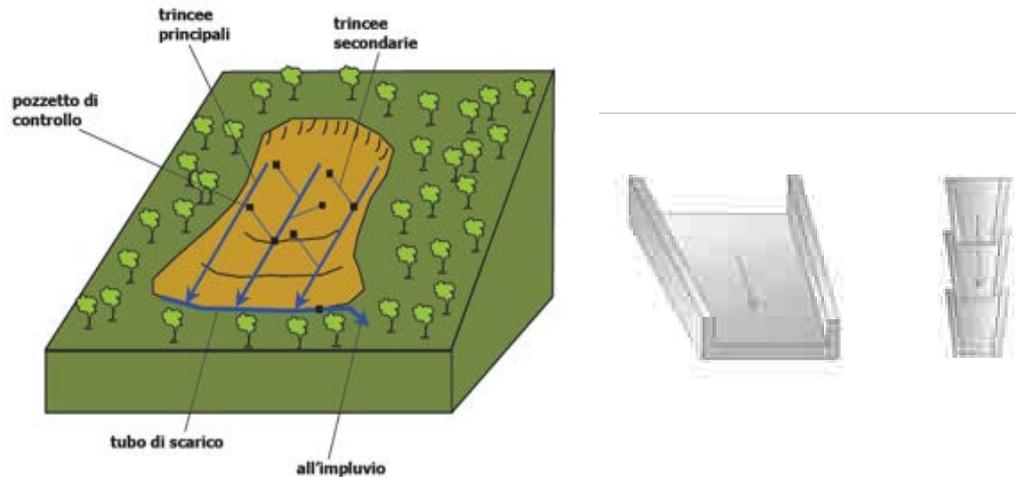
Disposizione planimetrica dei dreni superficiali e canalette rivestite in calcestruzzo.
